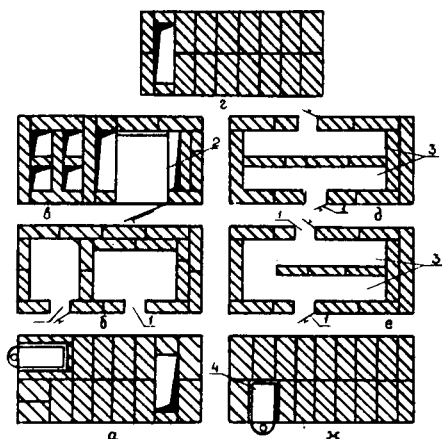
Кладка печи № 1 с 15-го по 26-й ряд: а — 15-й, 22-й ряды; б — 16-й ряд; в — 17—19-й ряды; г — 20-й ряд; д — 21-й ряд; е — 23-й ряд; ж — 24—26-й ряды; 1 — окна чистки; 2 — духовка; 3 — горизонтальные дымообороты; 4 — задвижка
